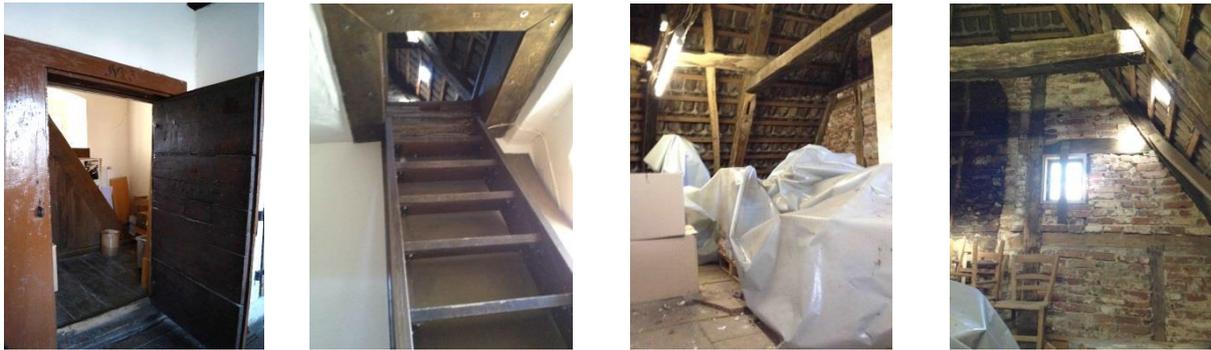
22: Gefängniszelle mit Treppe; Treppe ins Dachgeschoss; Dachraum West- und Nordwand
